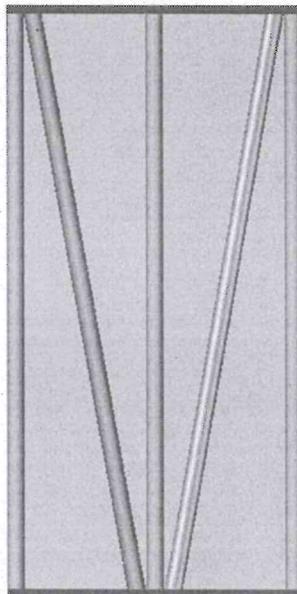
Un tipo de Biopanel® de 1.22 m x 2.44 m.
